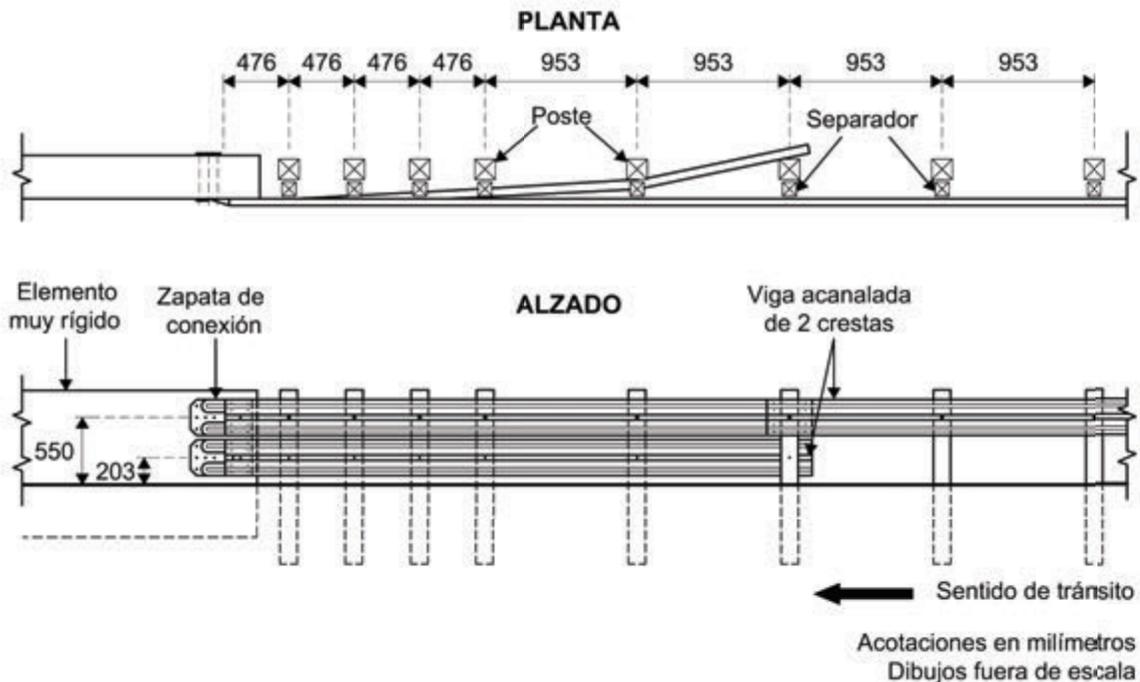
Transición de barrera metálica de doble banda a muro vertical recto
